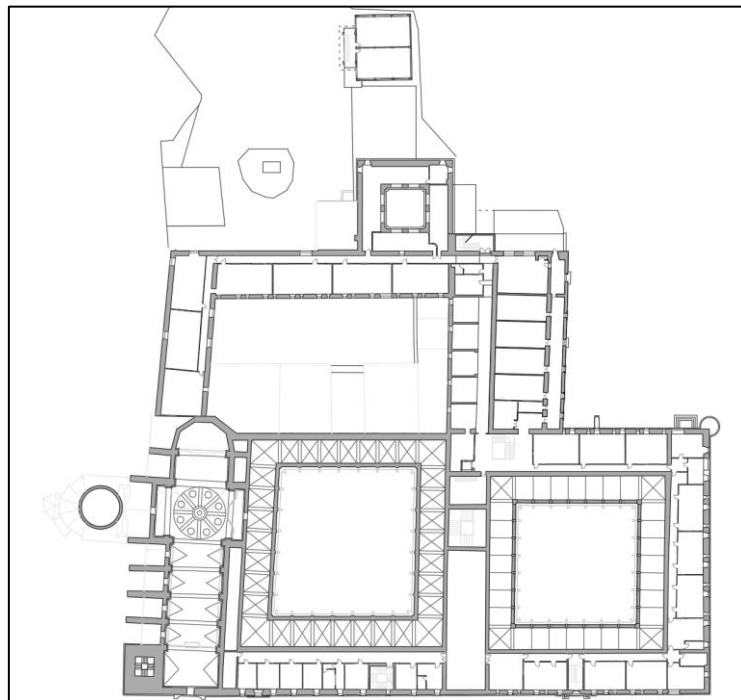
Plano de planta segunda del Colegio BIC.
